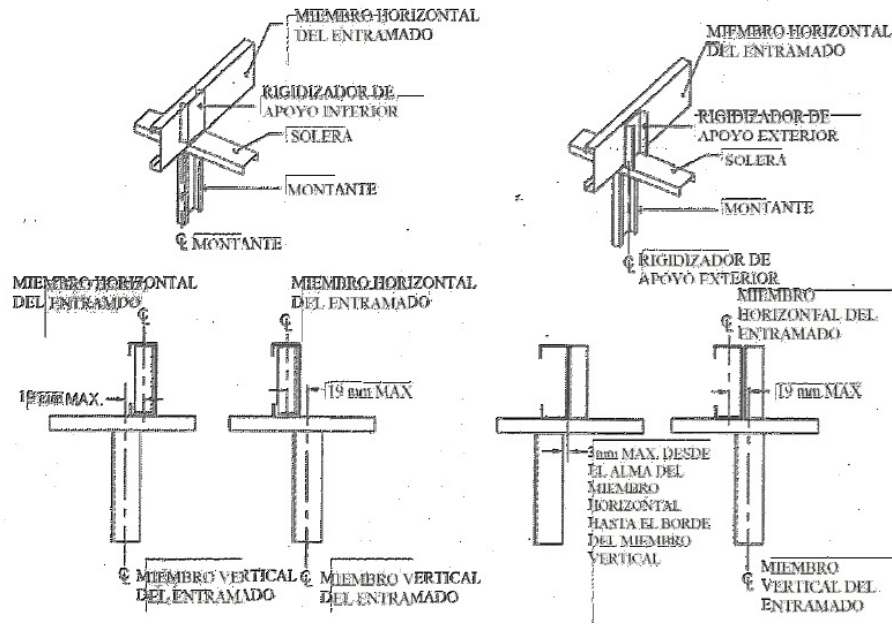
Detalles de alineación de los miembros estructurales de los muros portantes del (Steel Framing) Sistema Estructura Livianas, SEL
